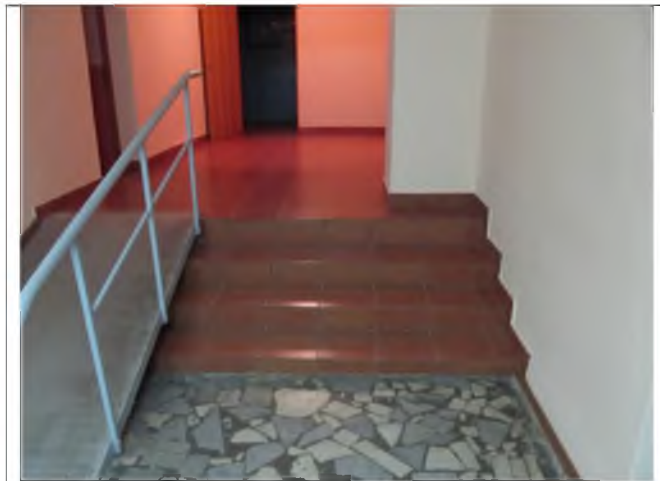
Путь (пути) движения внутри здания (лестницы)
